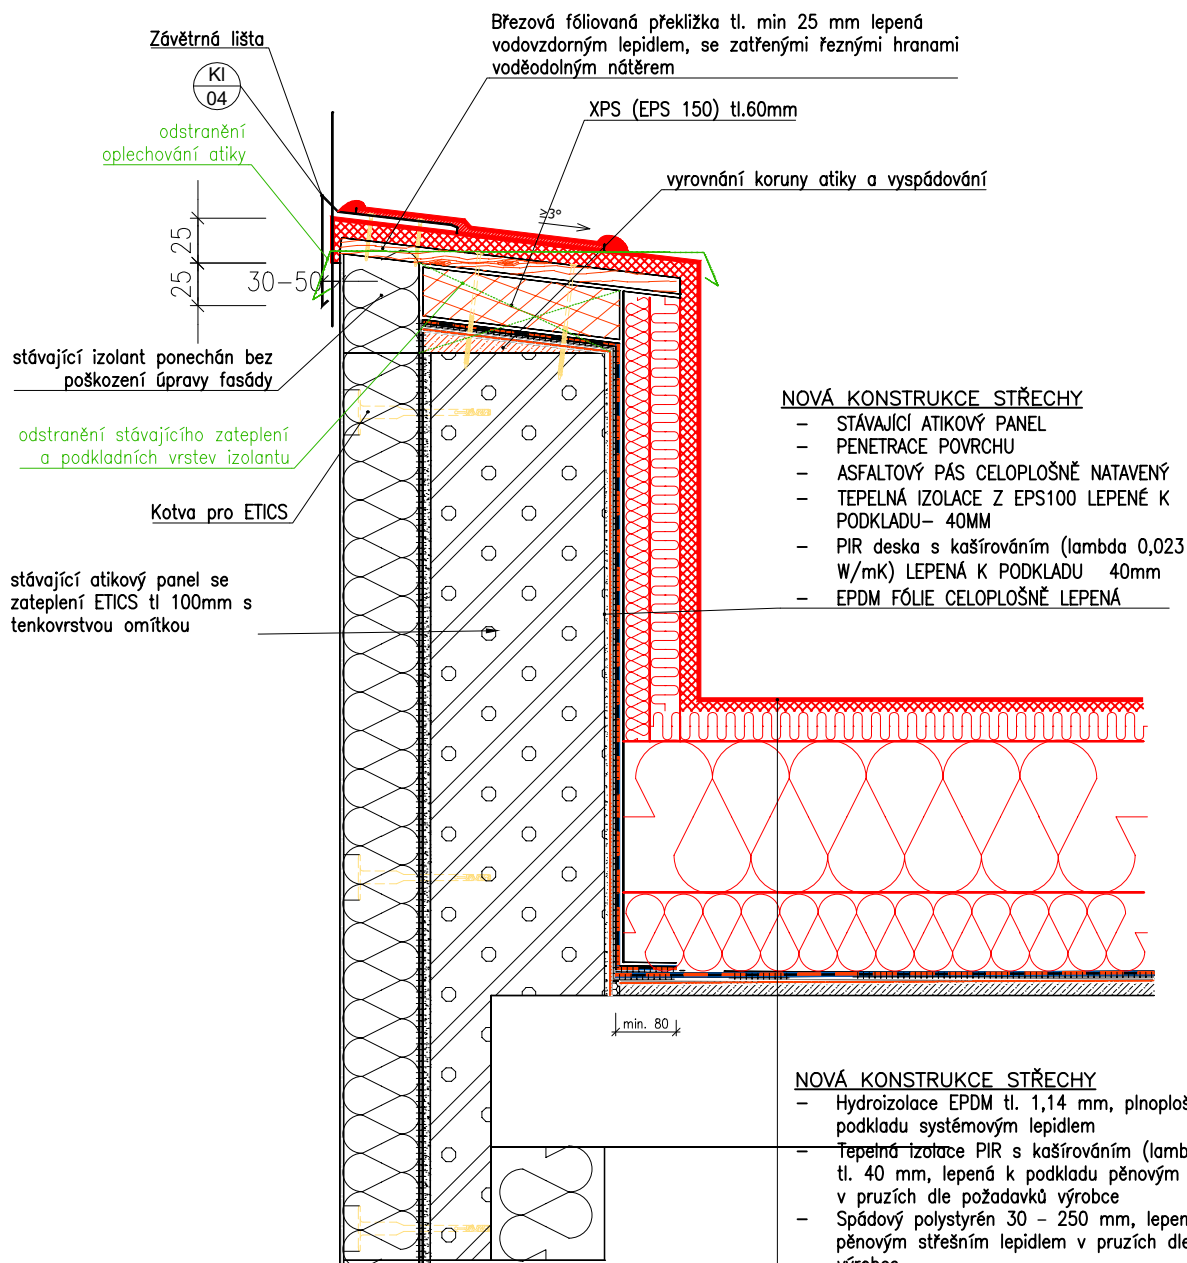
DETAIL ATIKY (PŮVODNĚ SE ZATEPLENOU KORUNOU ZDIVA)
